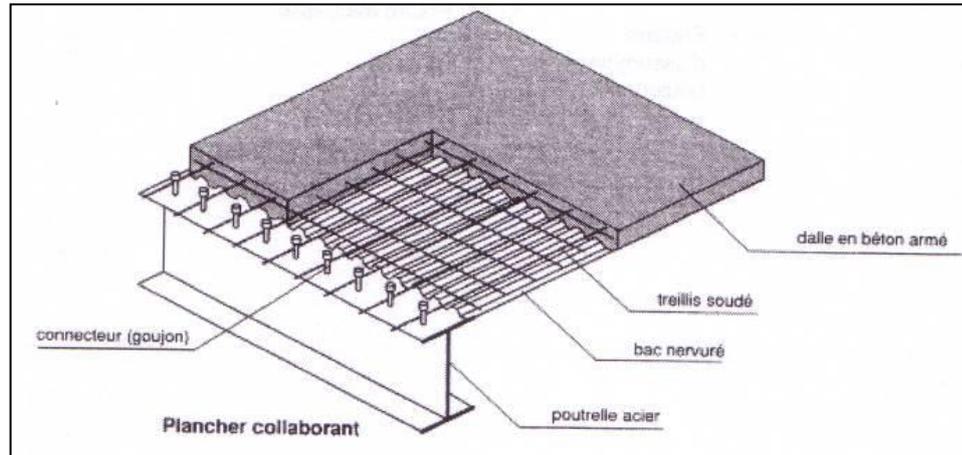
schéma présentatif du plancher collaborant /source :<https://notech.franceserv.com/planchers.html>
